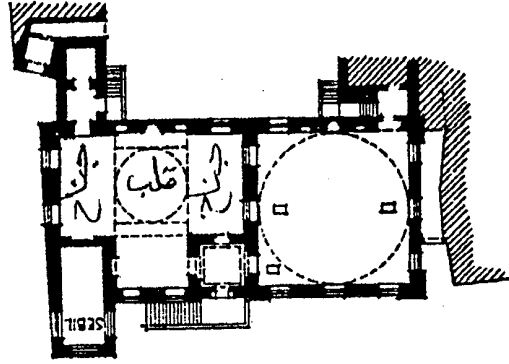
مسقط أفقي لجامع المؤيد شيخ لبسكال كوست
